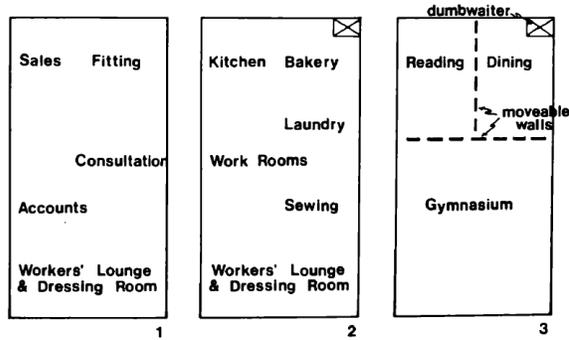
Diseño esquemático planta de Melusina Fay Pierce. Fuente: The Grand Domestic Revolution. Hayden, 1981
